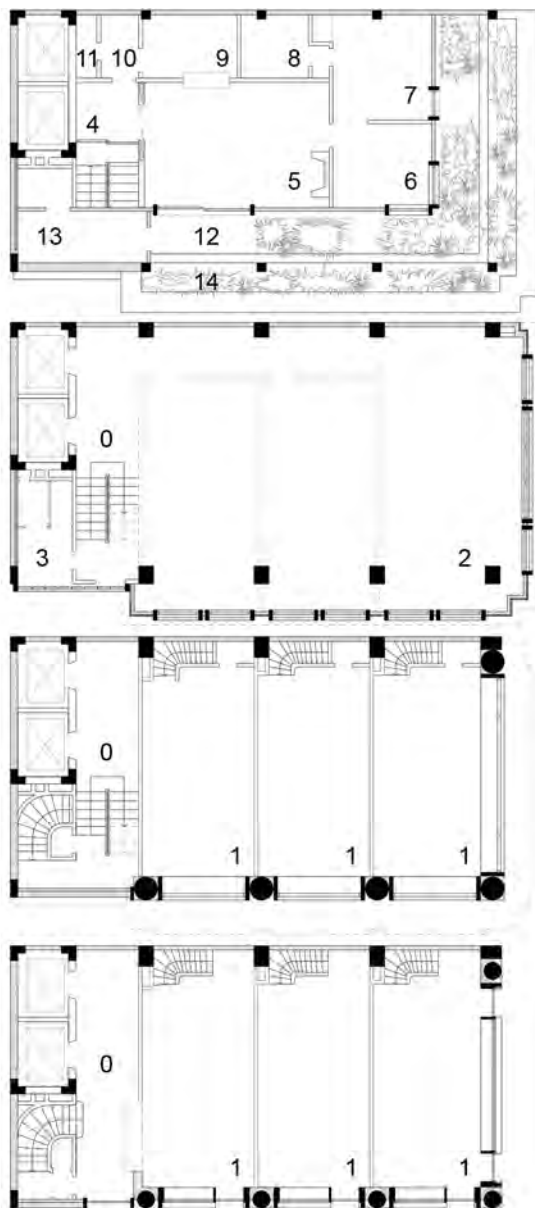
Quintana, dall'alto verso il basso, planimetria piano attico, tipo, mezzanino, terra. 0. Vano scale ascensori; 1. Negozi; 2. Uffici; 3. Servizi; 4. Vestibolo; 5. Salone; 6. Studio; 7. Stanza da letto; 8. Bagno; 9. Cucina-Bar; 10. Stanze da Letto; 11. Distribuzione; 12. Wc; 13. Terrazzo; 14. Servizio; 15. Fioriera. Fonte: elaborazione dell'autrice.
